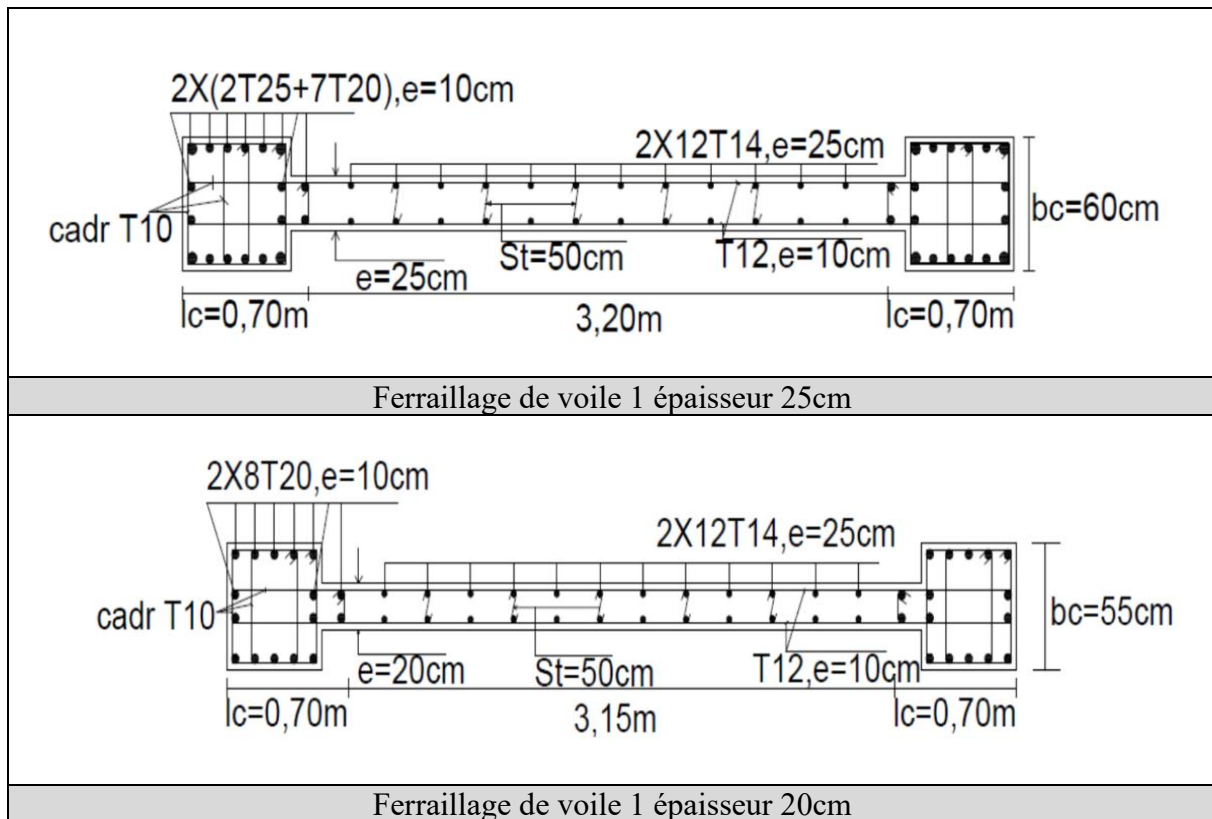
La coupe de ferrailage des voile 1 sens y.
